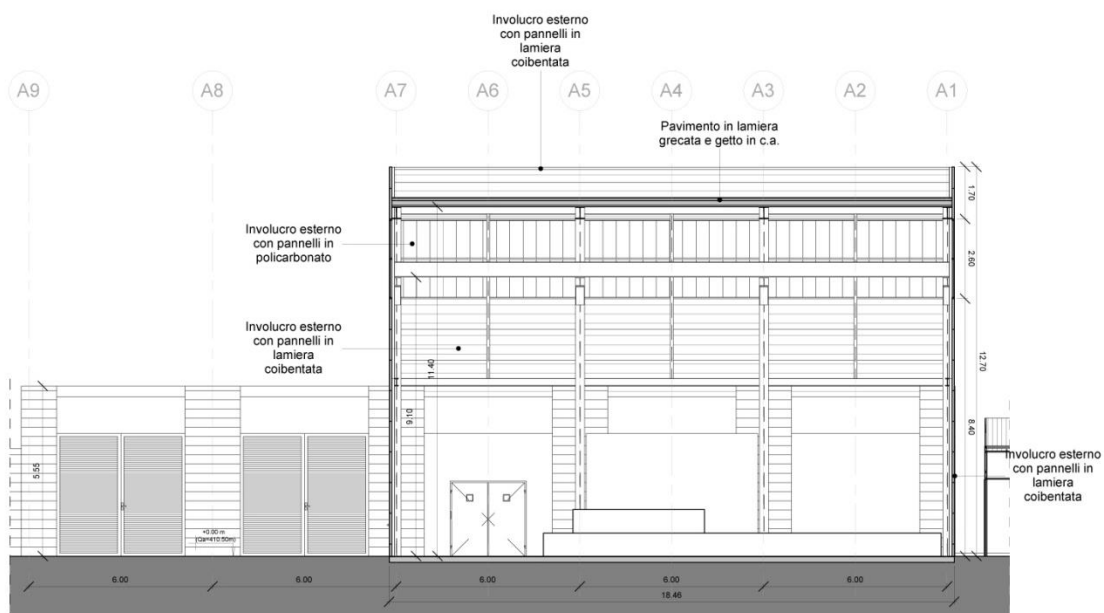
Edificio Ciclo Termico – Sezione longitudinale
